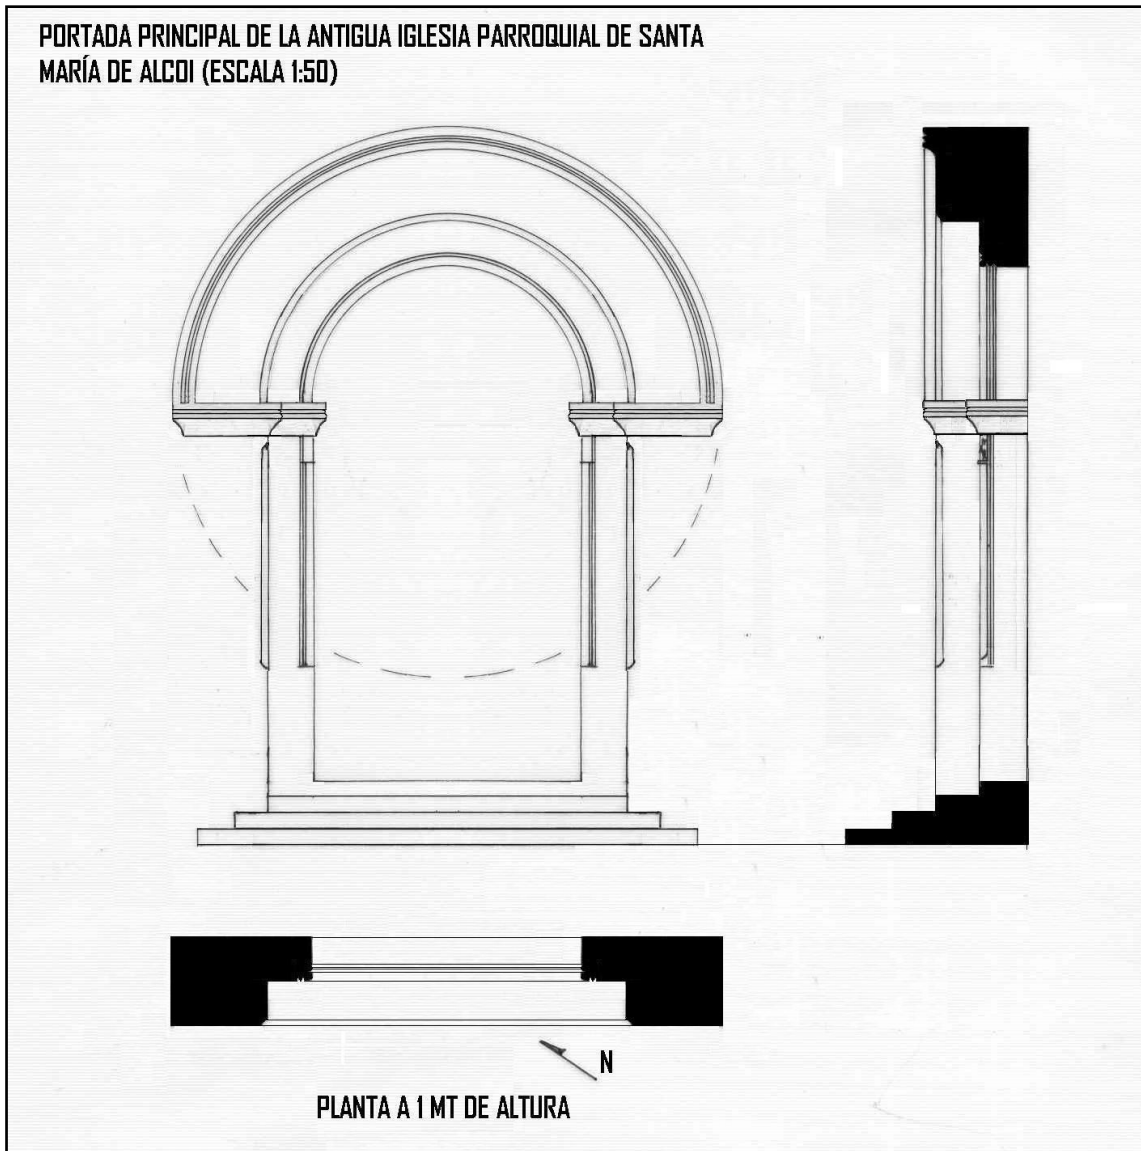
Vista de alzado, planta y sección de la portada SO (Francisco J. Soriano).
